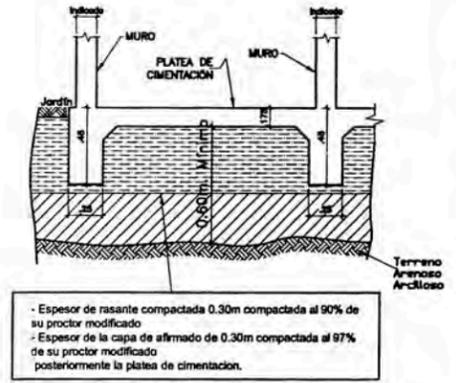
PLATEA DE CIMENTACIÓN (H = 0.175m.)
